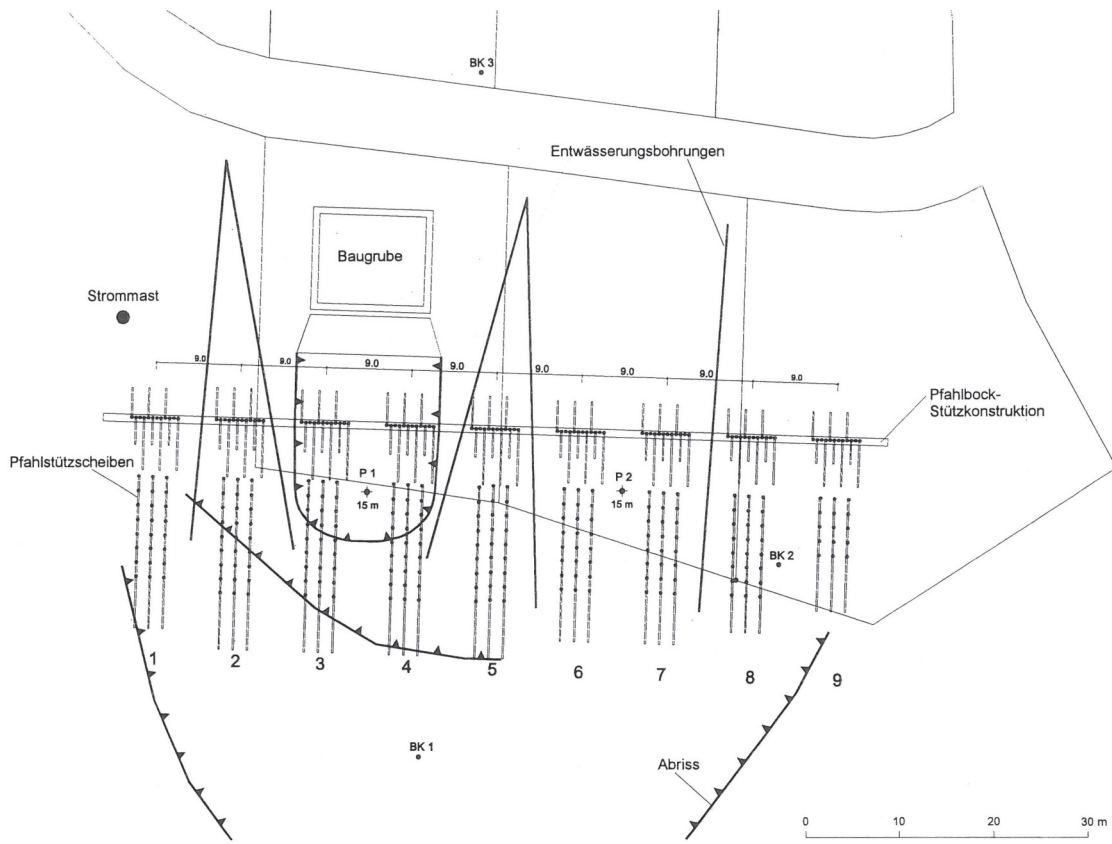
Detailplan der Sanierung mit Lage der Stützelemente.
